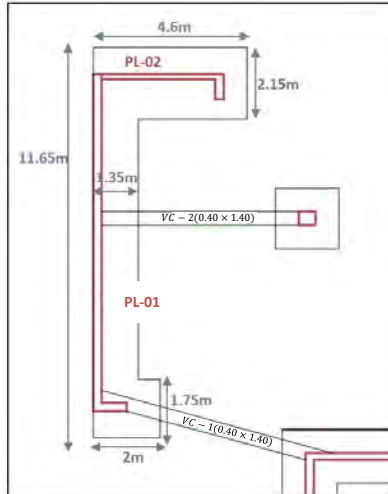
DIMENSIONES DE LA ZAPATA A DISEÑAR.
